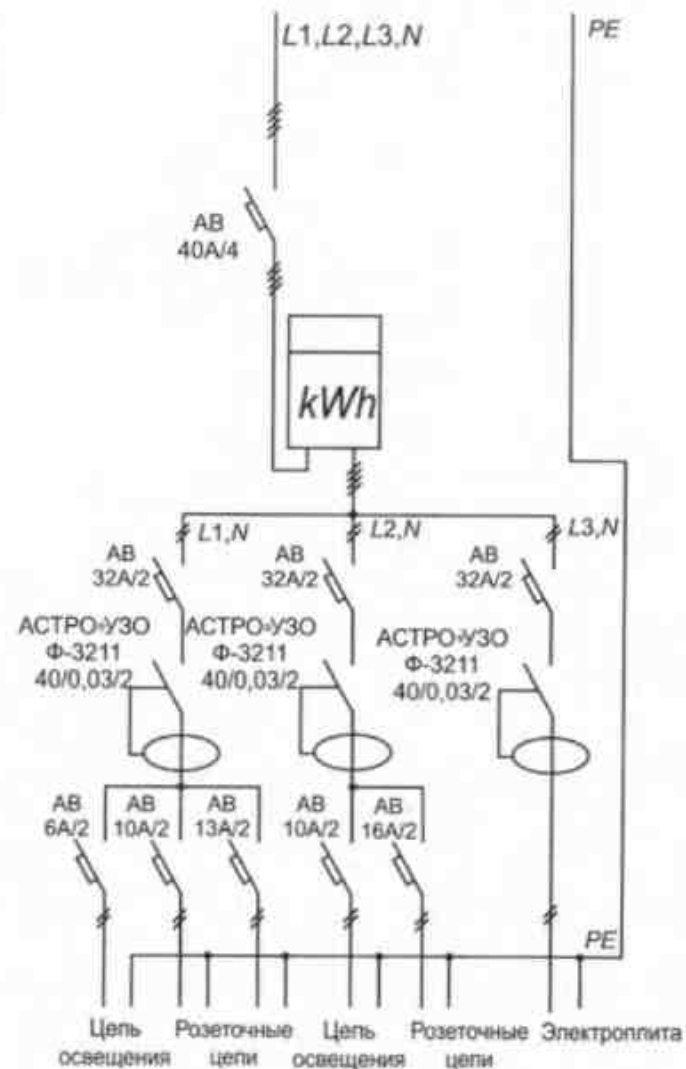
Схема электроснабжения здания с трехфазным вводом
